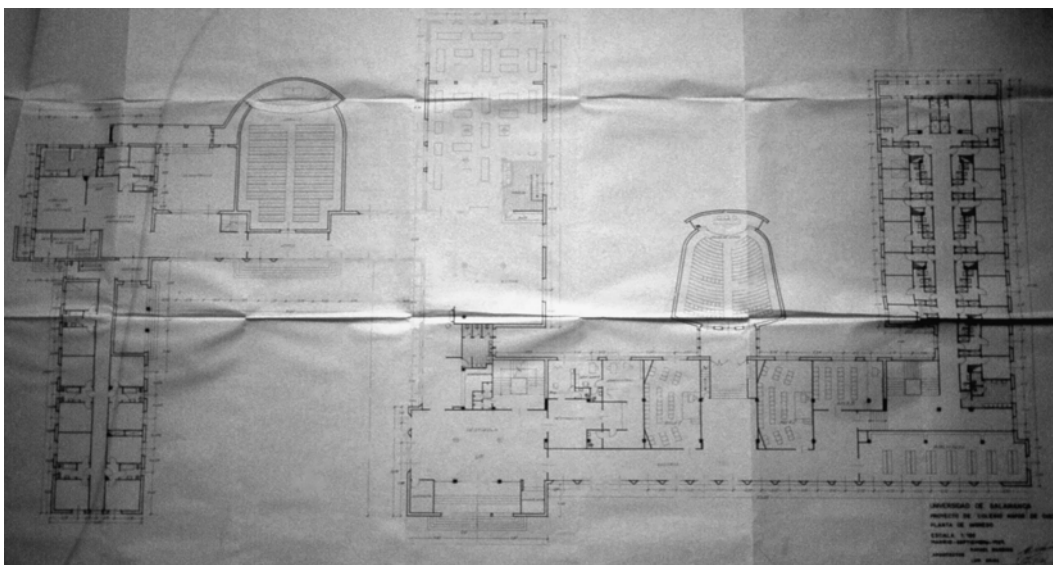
Proyecto de Colegio Mayor de Cuenca, planta baja.
